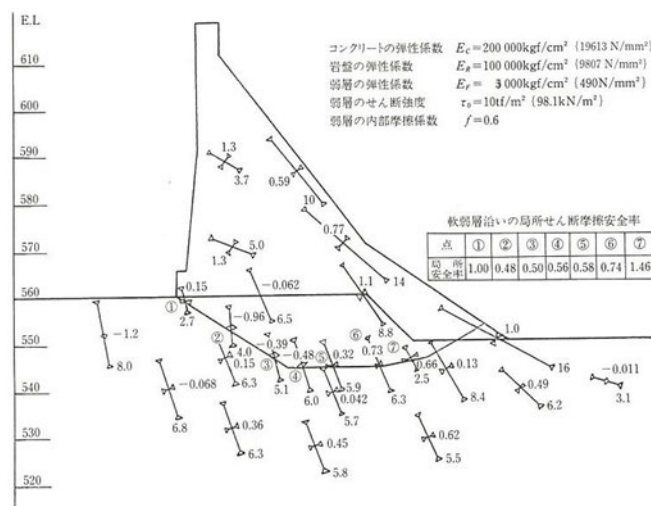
水平に近い弱層がある場合の重力式コンクリートダムの応力及び局所せん断摩擦安全率
